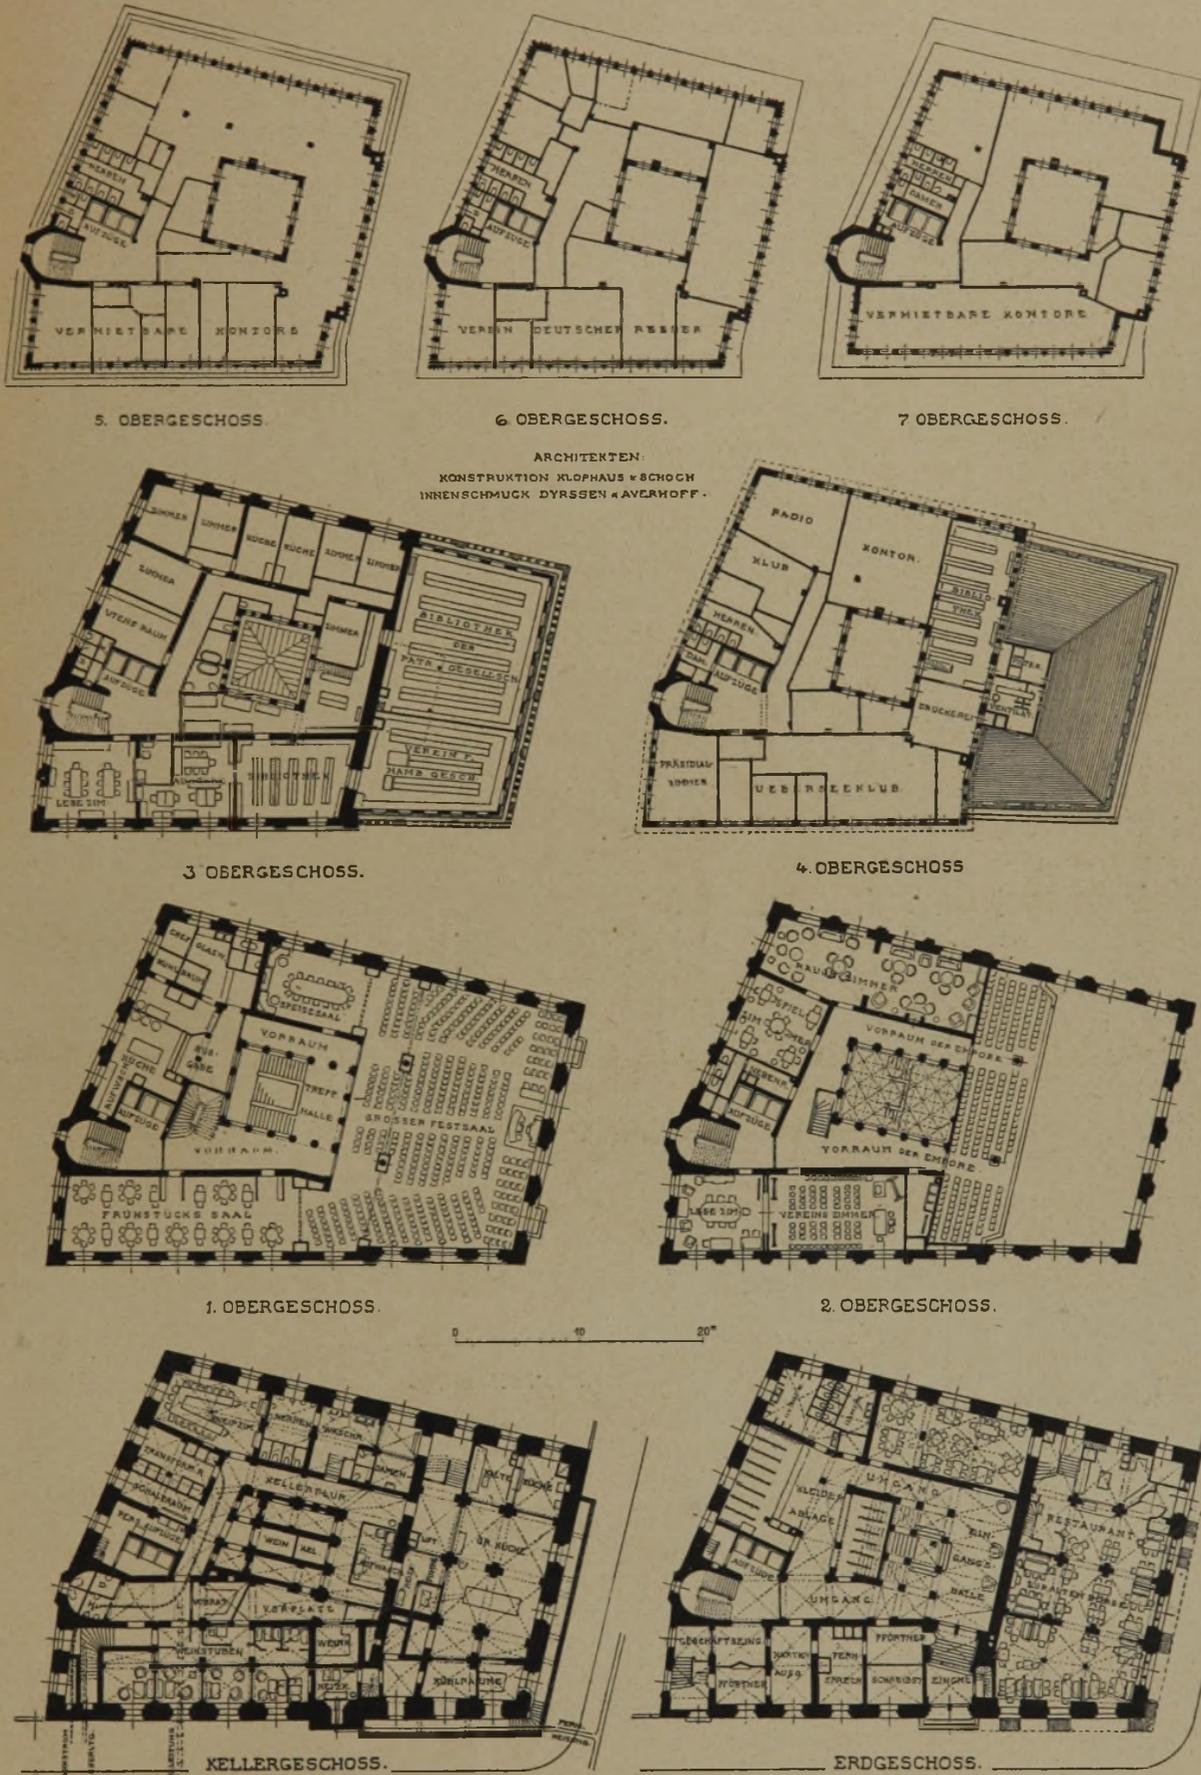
Grundrisse der alten Geschosse nach dem Umbau und der aufgebauten Geschosse.
